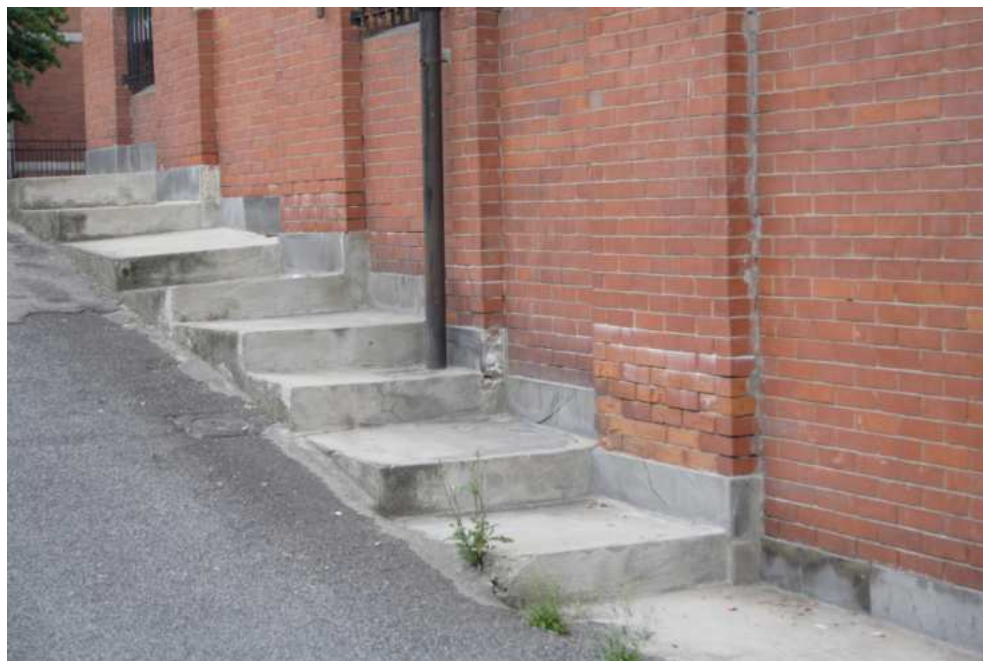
Particolare dell'ingresso al piano del giardino dalla strada, visibili degli ammaloramenti nella muratura, tra cui efflorescenze di sali dovuti forse alla risalita d'acqua capillare e/o dal dilavamento e mattoni fessurati per gelività.
